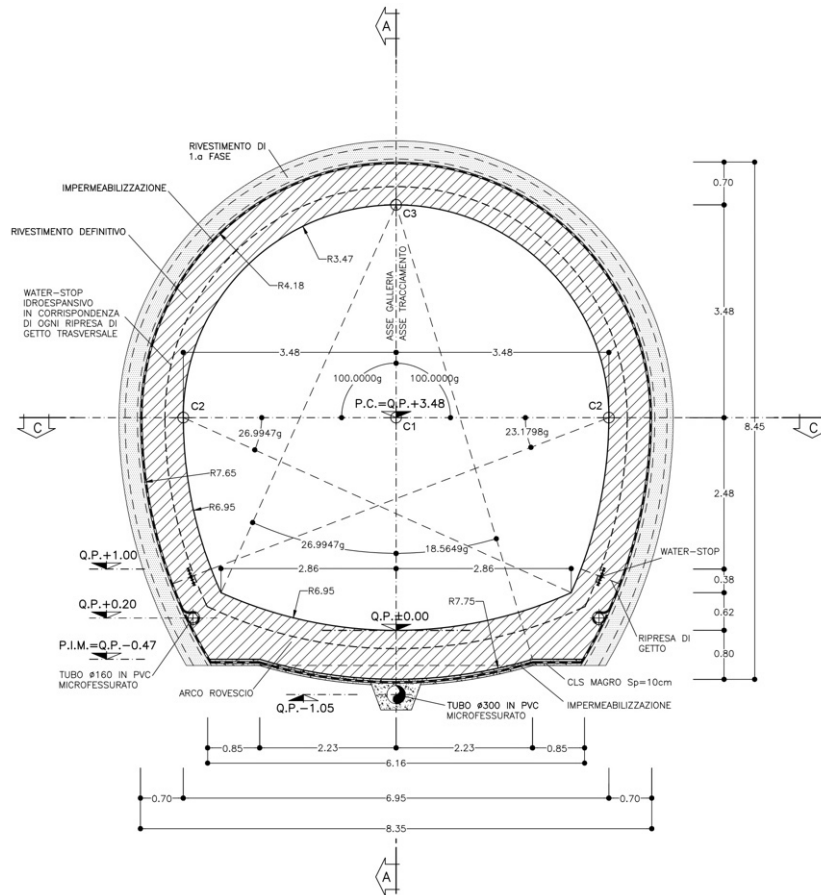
Sezione Tipo B2 – Carpenteria – Sezioni
